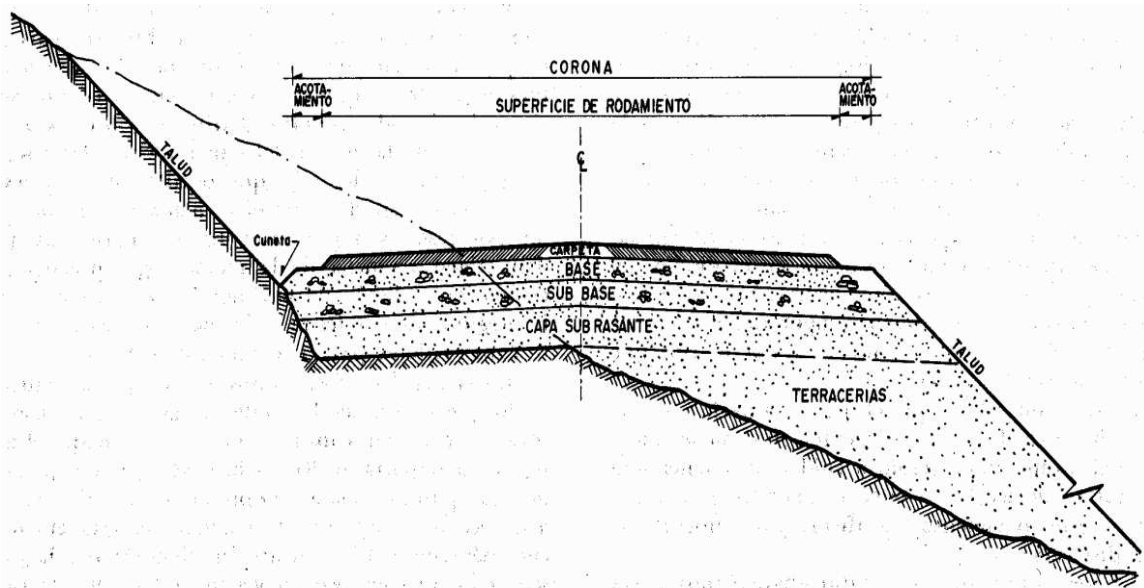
Sección transversal típica de un pavimento flexible (Rico y del Castillo, 1978).
